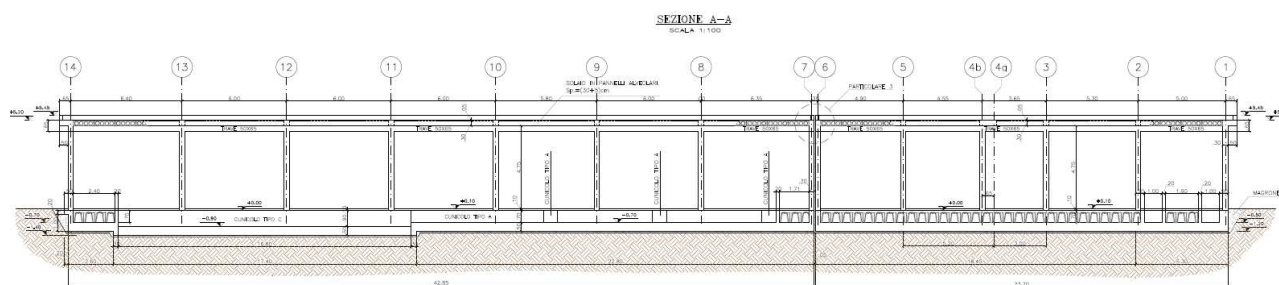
Sezione longitudinale carpenteria della sottostazione elettrica.
